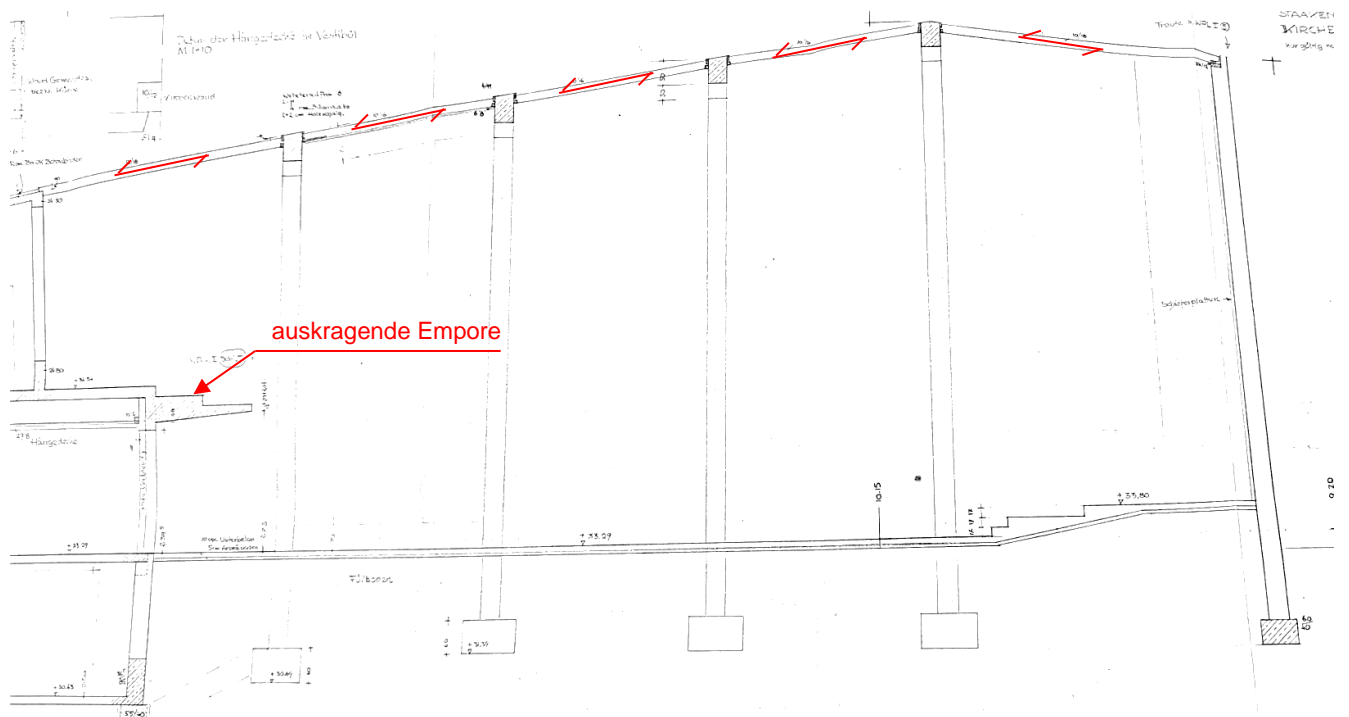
Auszug Bestandsplan [U 1] - Längsschnitt Stephanuskirche mit Gemeindehaus, kommentiert
